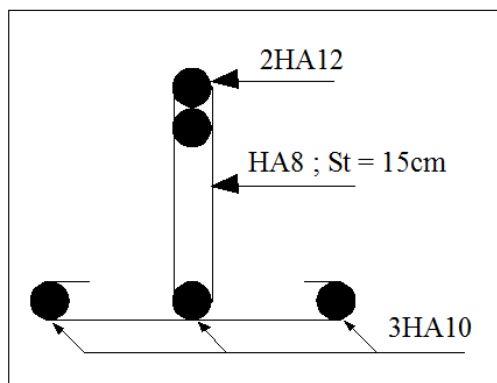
Schéma de ferrailage des nervures « plancher étage courant »
